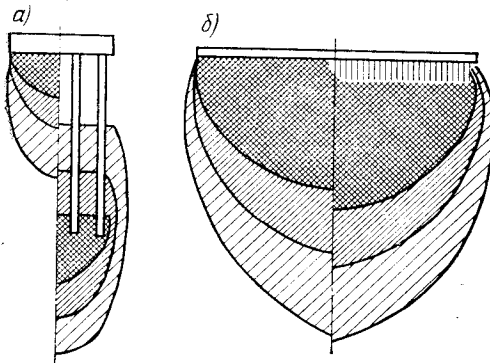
Изобары вертикальных напряжений в основании свайных фундаментов (по Б. И. Далматову):
